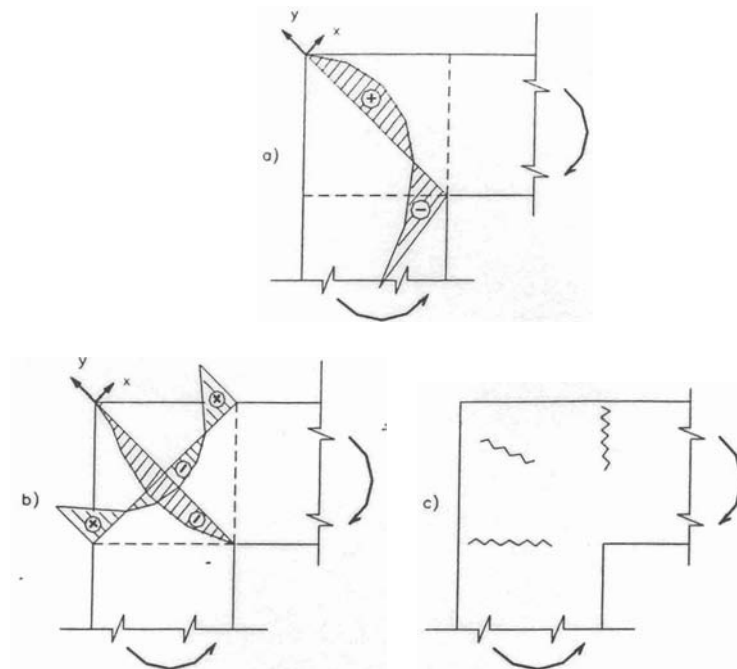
Distribuições de tensões em ligação viga de cobertura-pilar extremo para momento fletor tracionando as fibras externas, adaptado de SILVA (1991)
